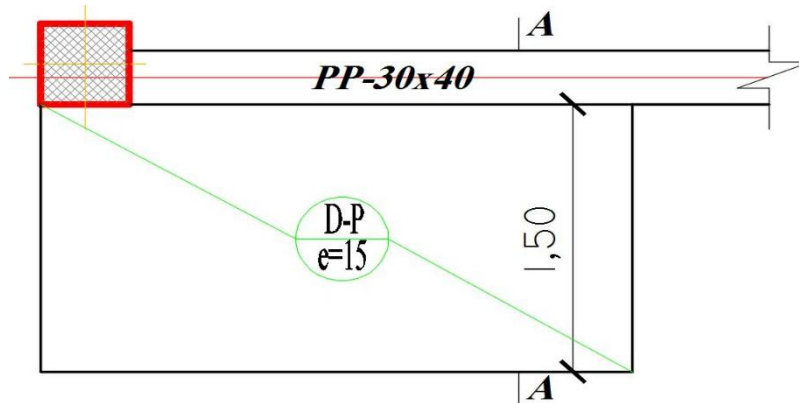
Schéma de (porte à faux) Dalles pleines
